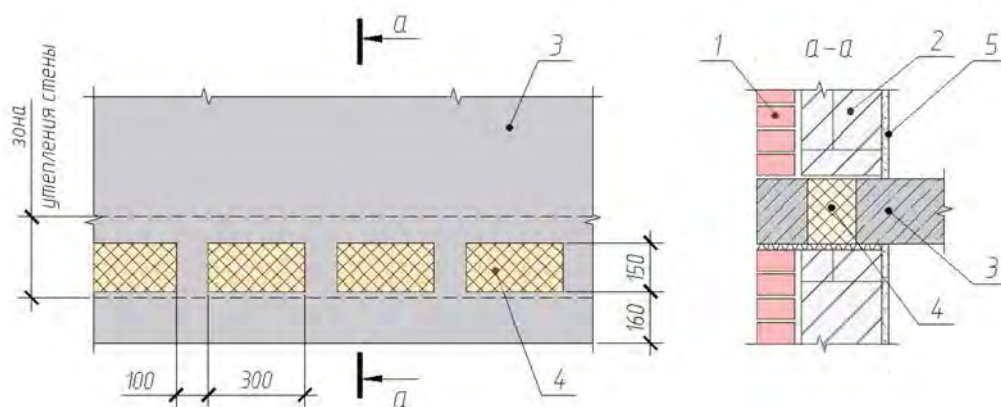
Стандартный узел сопряжения диска перекрытий с наружной стеной:
